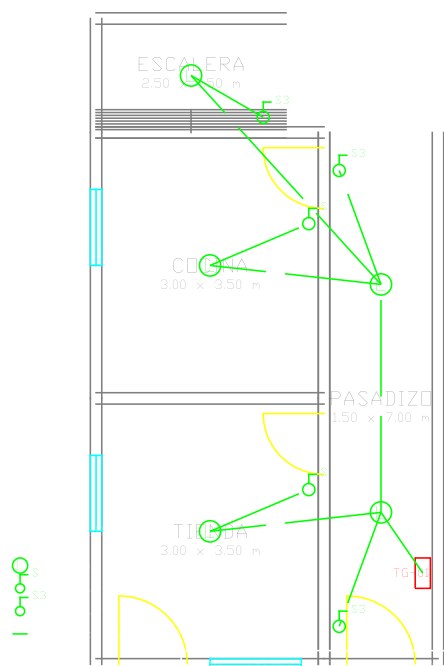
Plano de Instalaciones Eléctricas (Alumbrado e Iluminación) - Primer Piso
